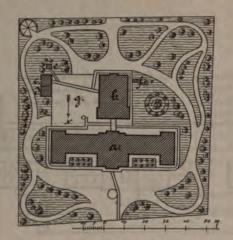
Städtisches Krankenhaus zu Langensalza. Lageplan.
